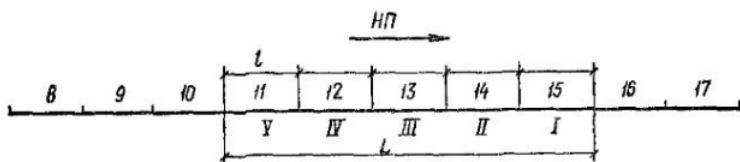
Схема разбивки теплопровода на участки и захватки
